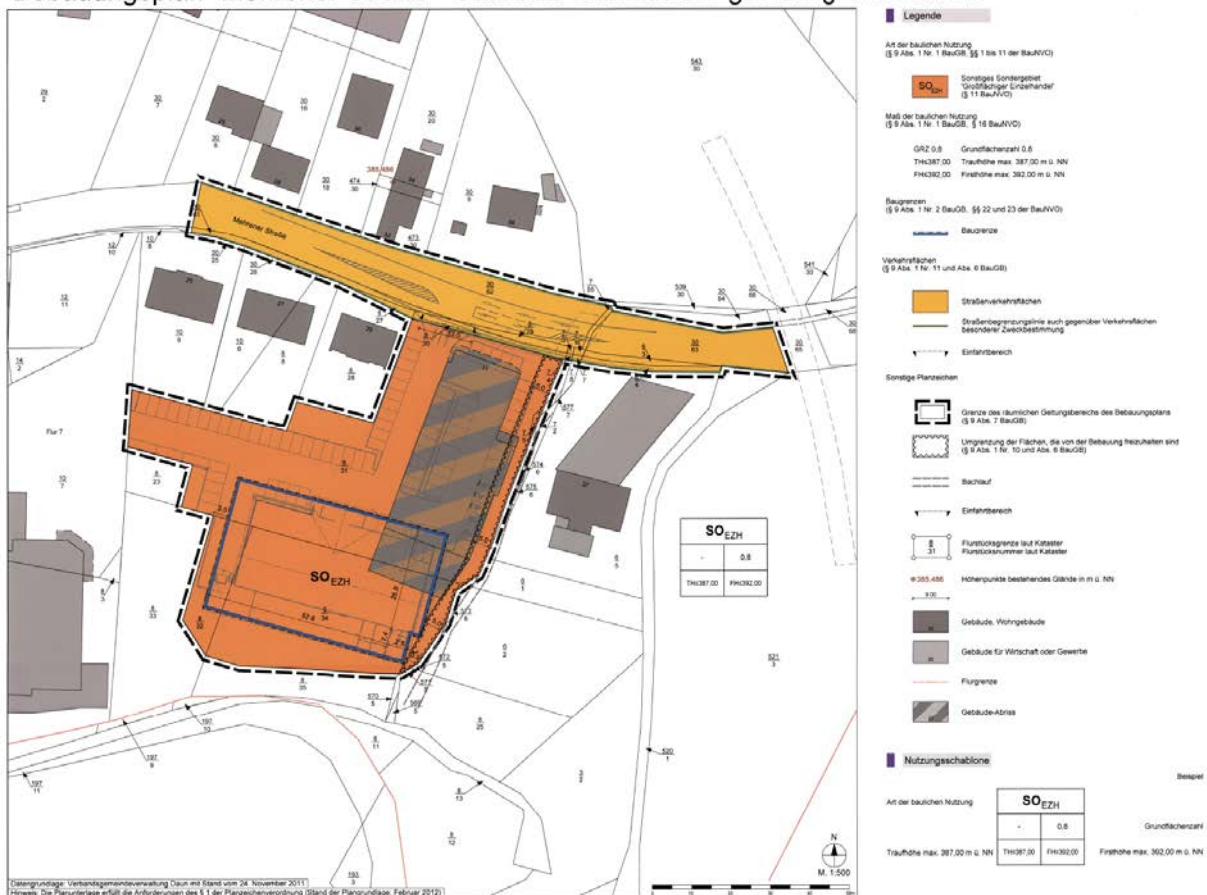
Bebauungsplan „Mehrener Straße – Südlicher Teilbereich“, Quelle VG Daun
